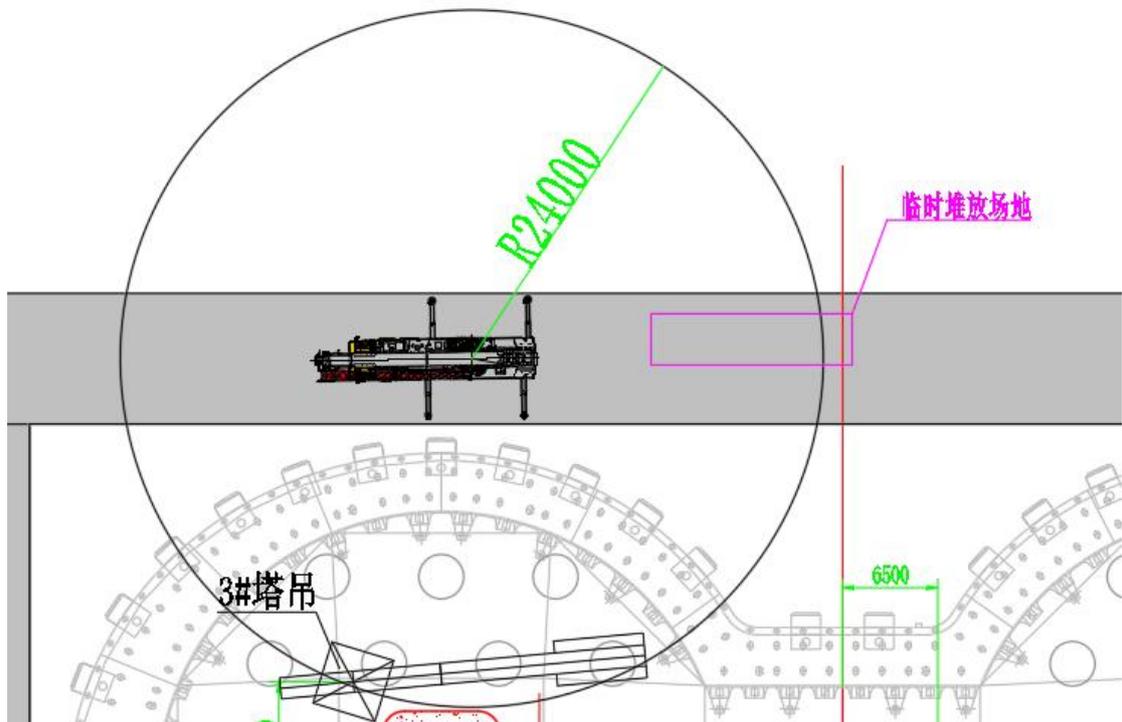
3#塔吊平衡臂吊装平面示意图
